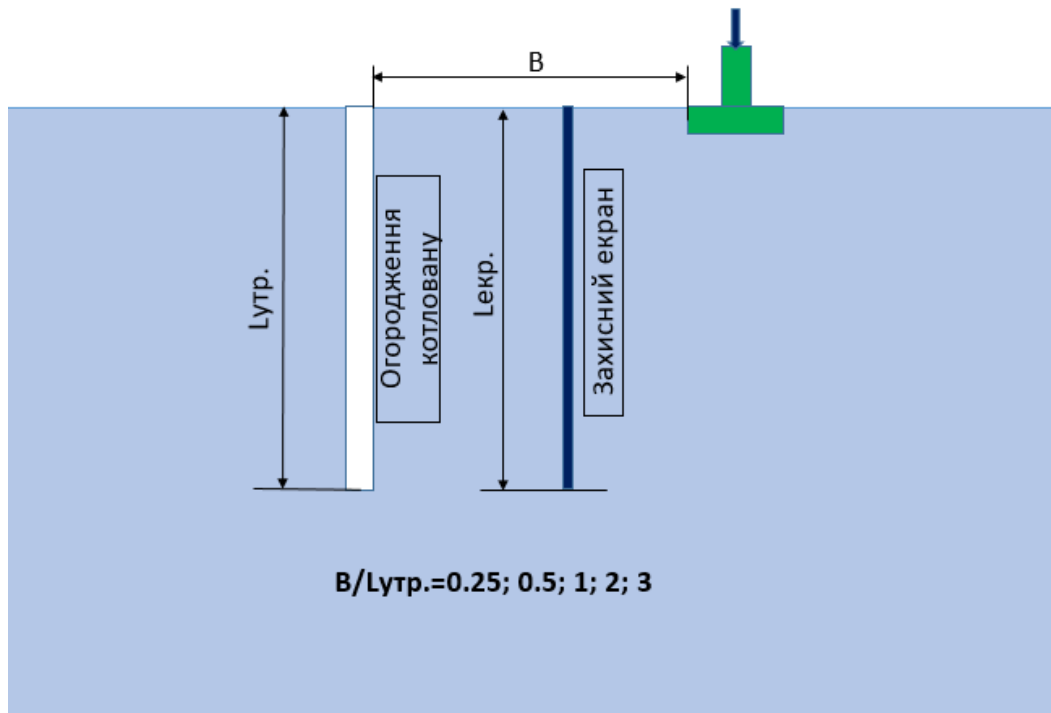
Розрахункова схема при дослідженні відстані між існуючим будинком та котлованом при застосуванні захисного екрану
